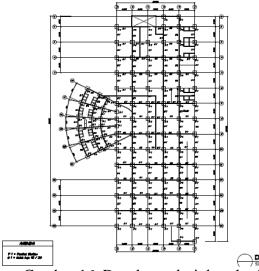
Denah pondasi dan sloof gedung pengelola (Sumber : Pengembangan Desain)
